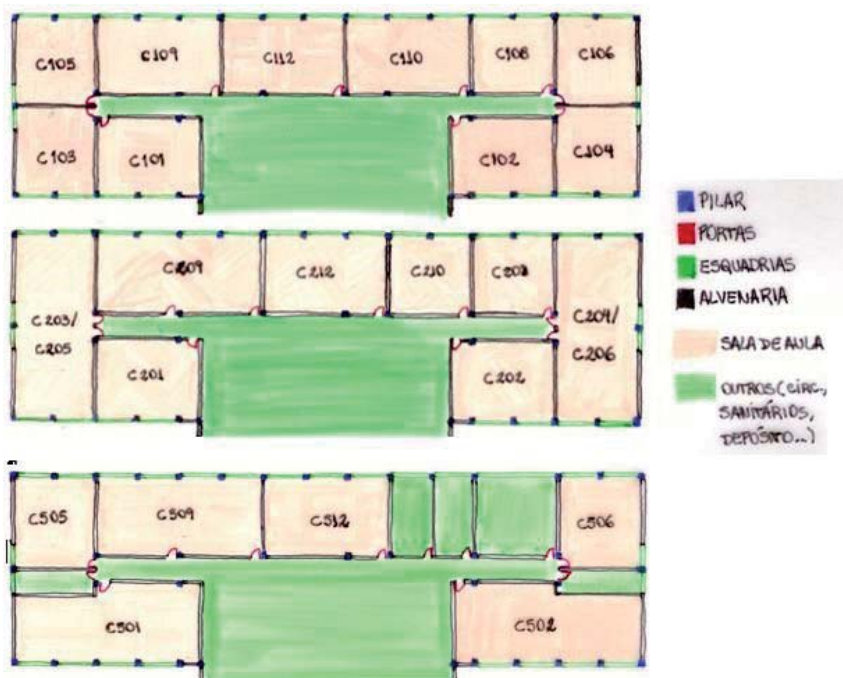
Croqui do Bloco “C” da IES, 3º, 4º e 5º pavimentos e as salas de aula
